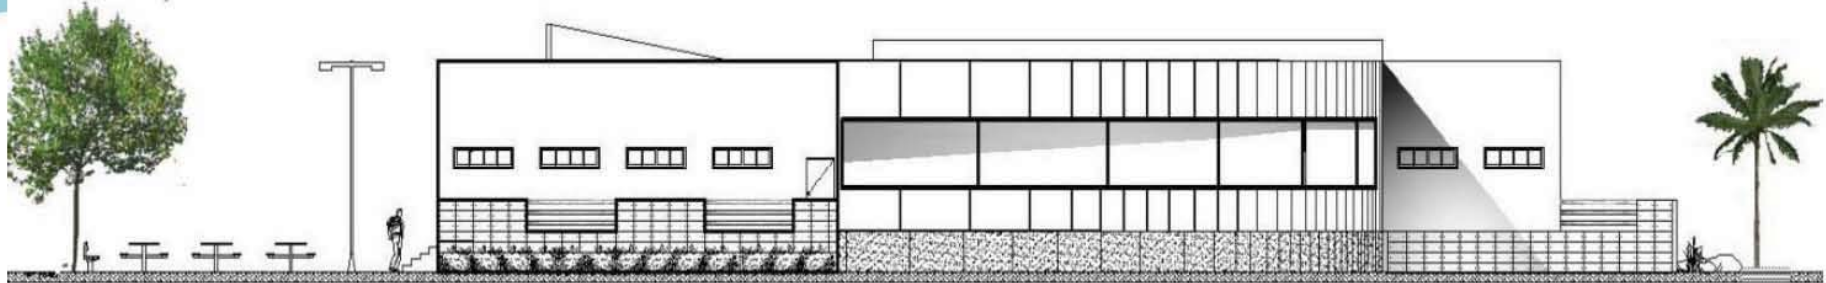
Fachada Nor-este, volumetría semicircular donde se ubican las oficinas
